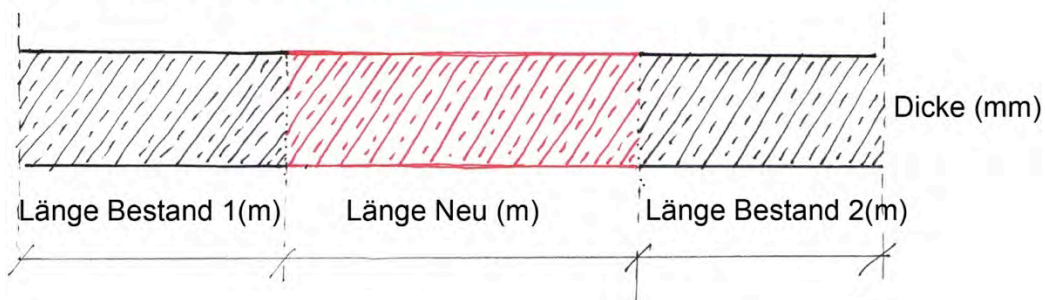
Wand Öffnung Schließen, Bestand und Neu Stahlbeton
